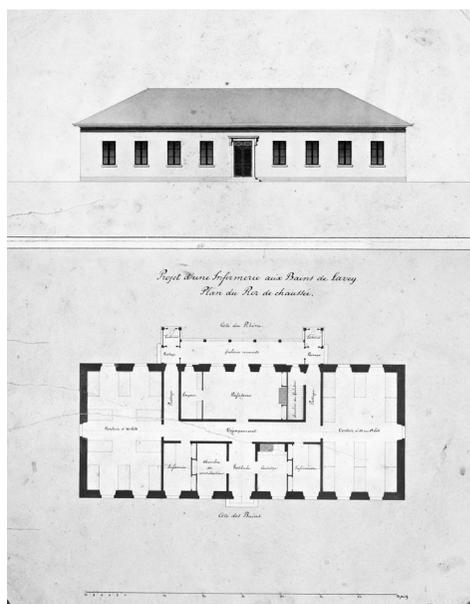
Lavey, infirmerie, projet de Louis Wenger, élévation de la façade d'entrée et plan, 1841 (ACV).
